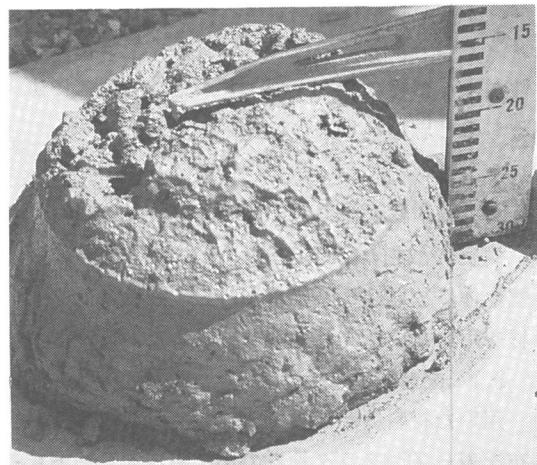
放射線遮蔽コンクリートの打設および仕上がり状況
